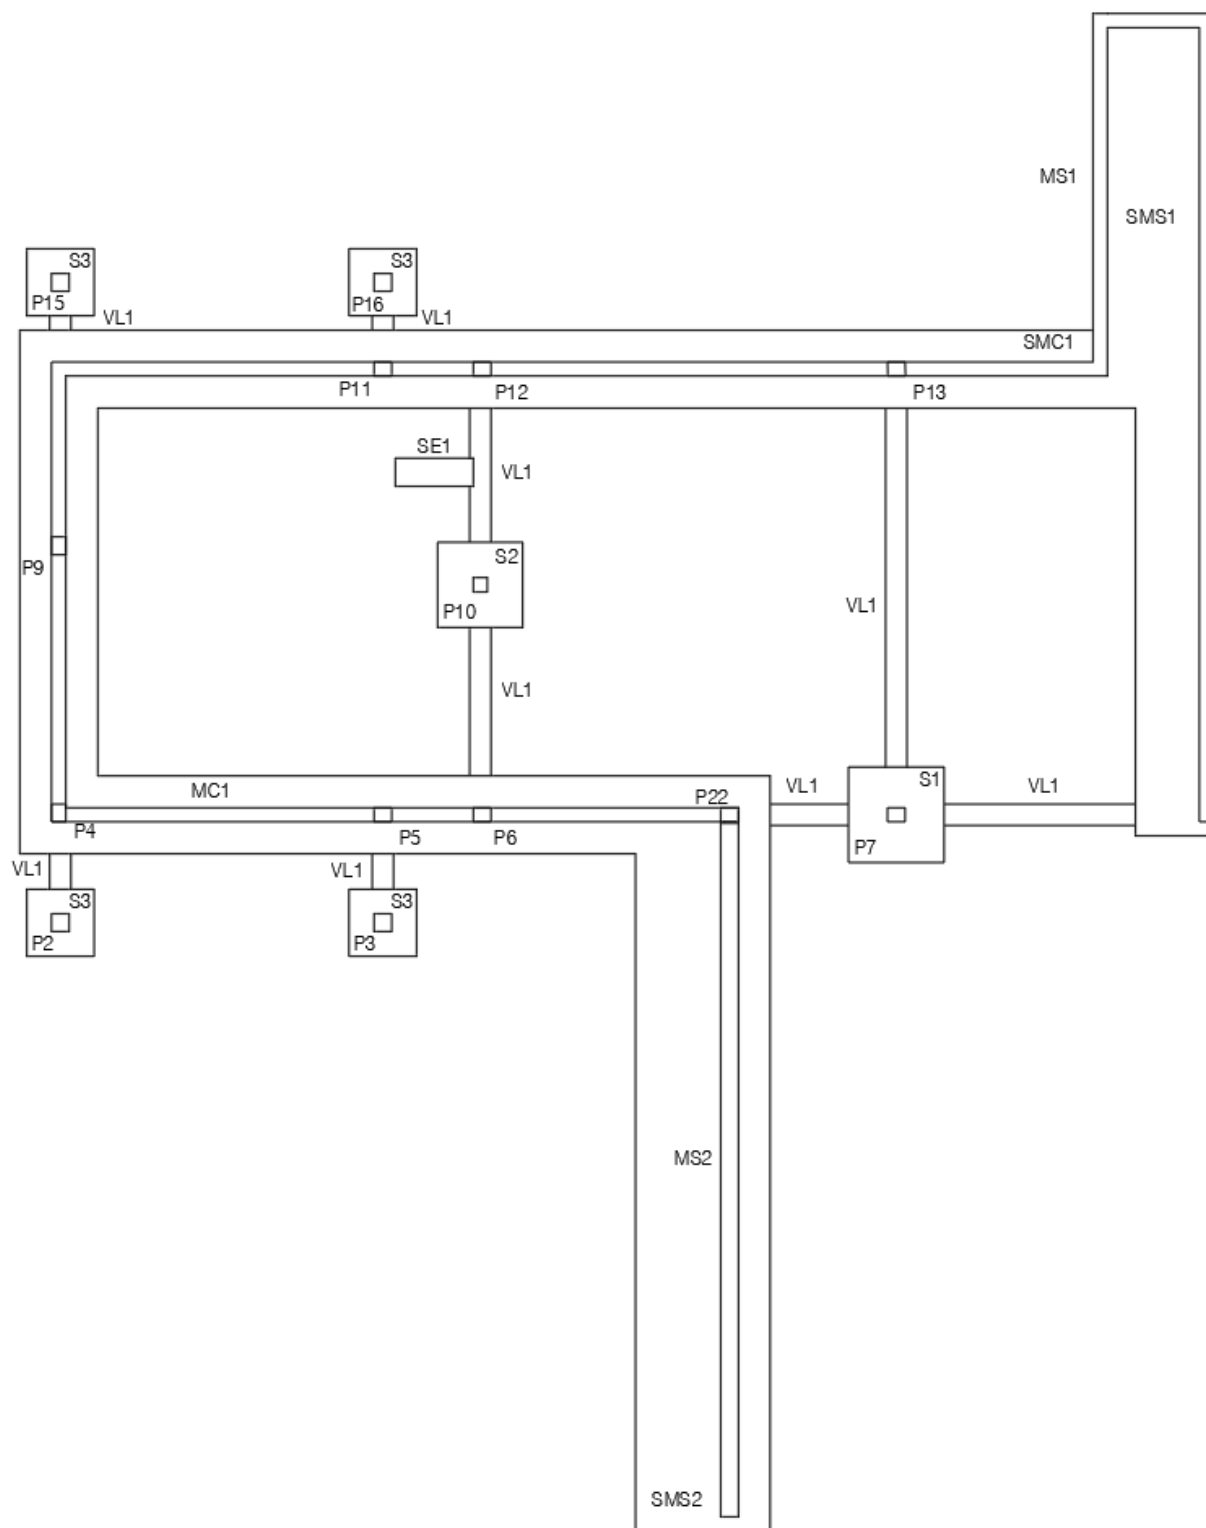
Esquema estrutural da fundação – nível 1 (Projeto de estruturas).
